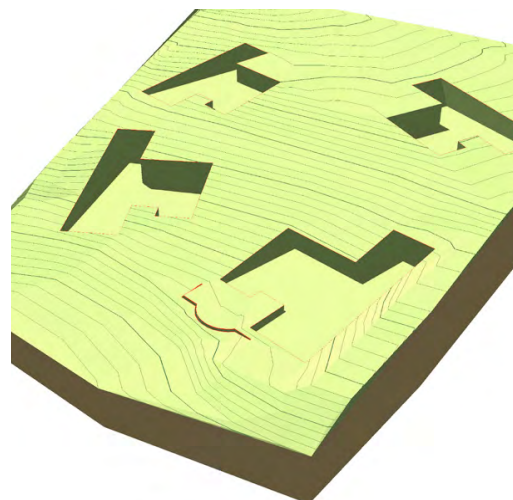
Geländeoberfläche mit Auf- und Abtrag in einem Geländemodell
